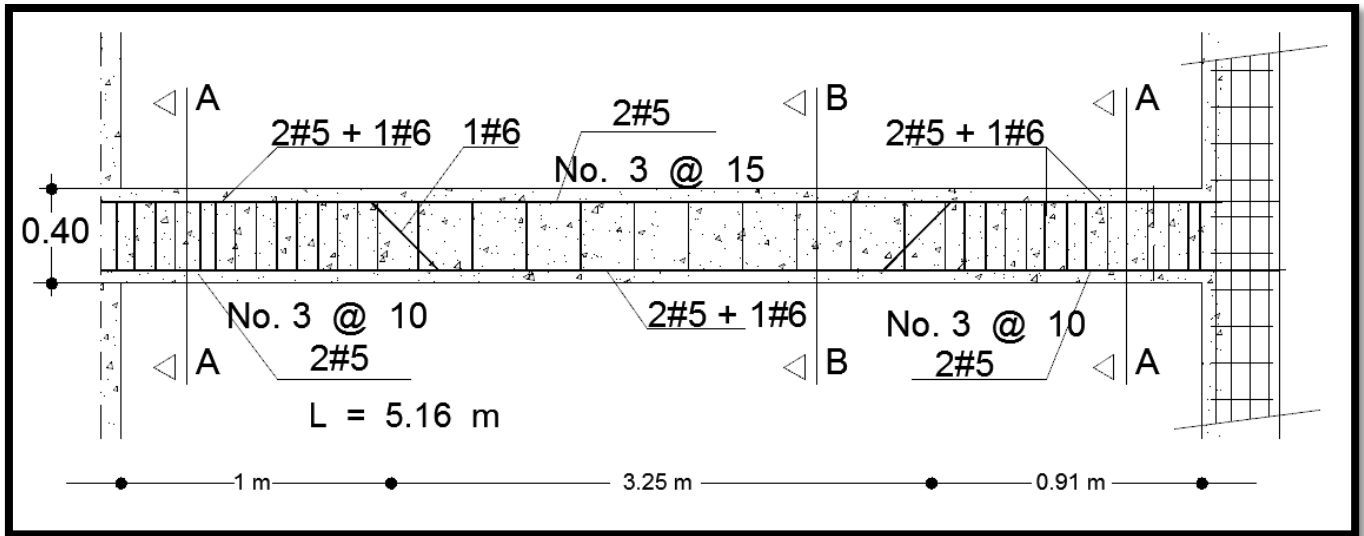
Viga E4 del pórtico A1-A5, Cuerpo 1
